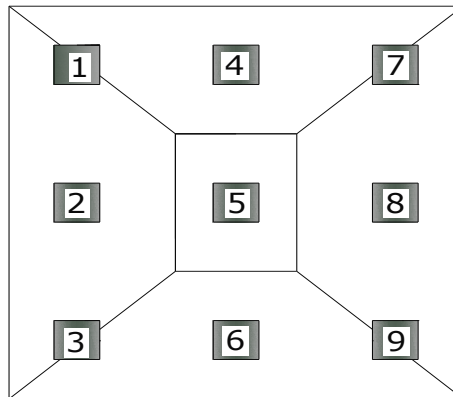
Zapata cabezal construida sobre nueve pilotes – vista en planta
